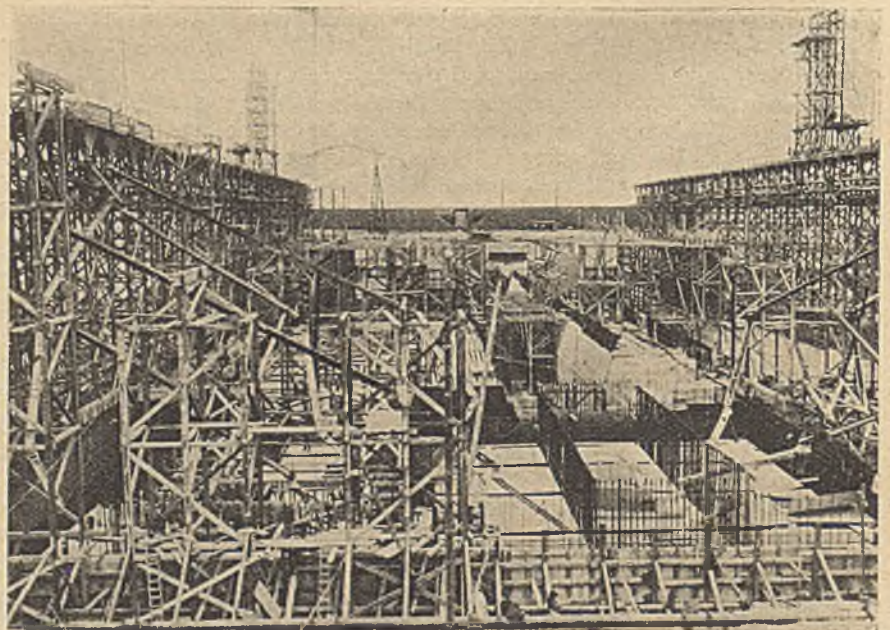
Betontransportgerüste (fahrbare Gießtürme im Bau).
